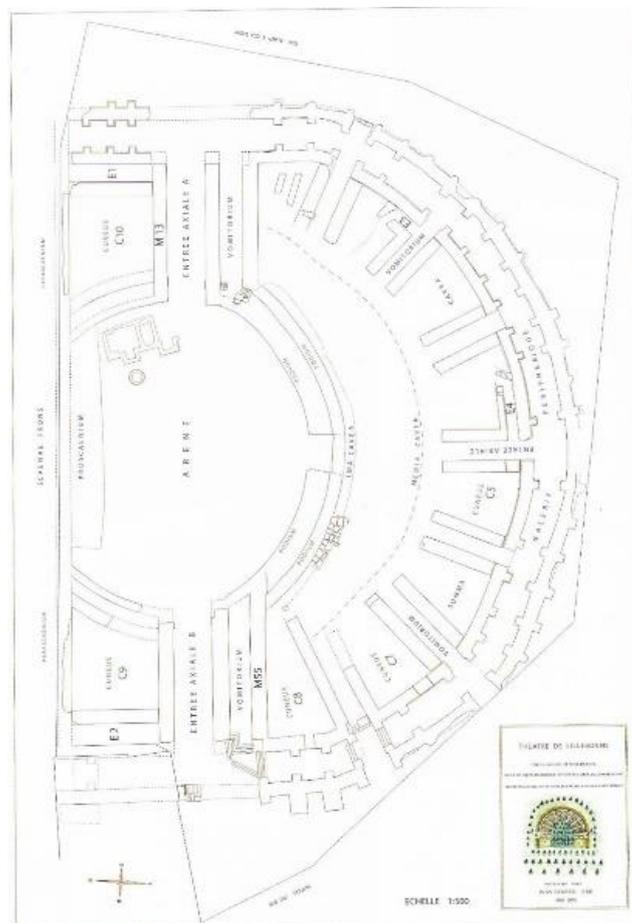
Plan du théâtre (V. Mutarelli, 2008).
